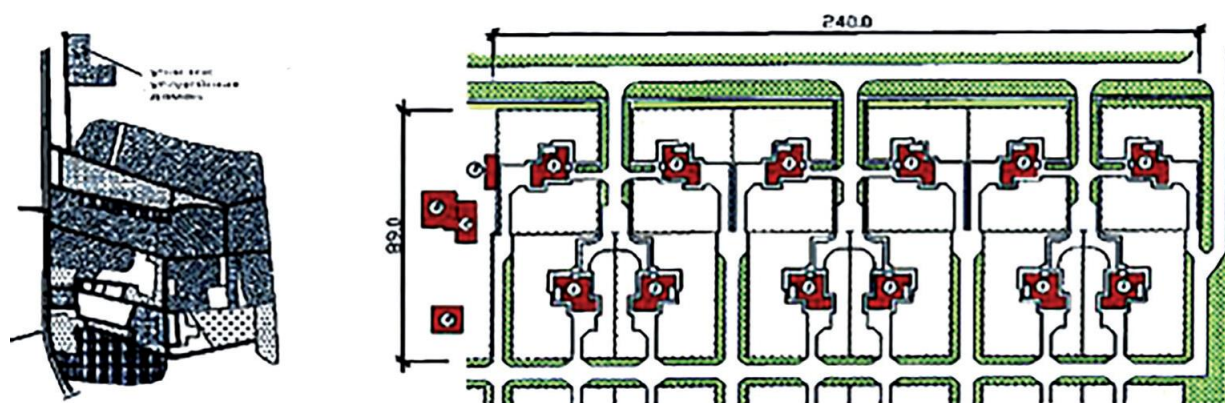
Ситуационная схема и генеральный план комплекса жилых домов
